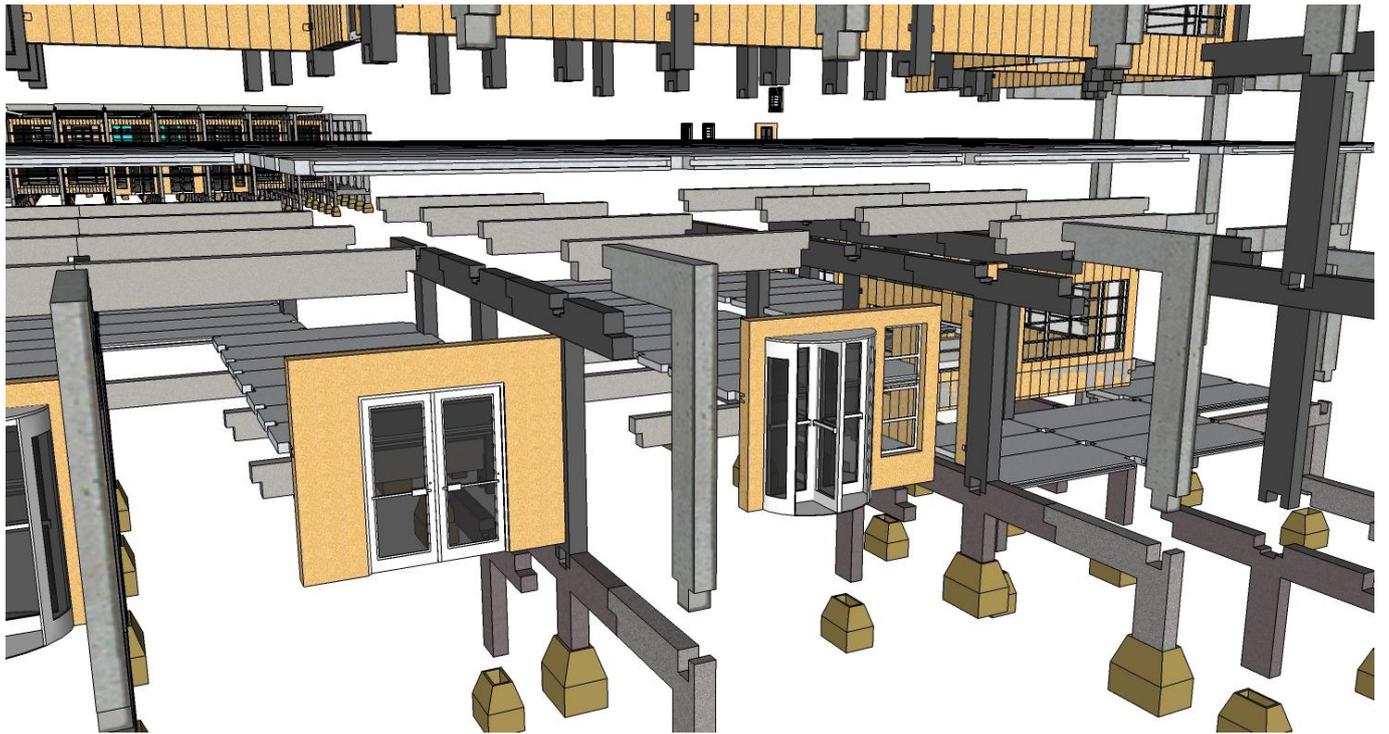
Exemple d'assemblage semelle , amorce, poteau, et cloison en beton
